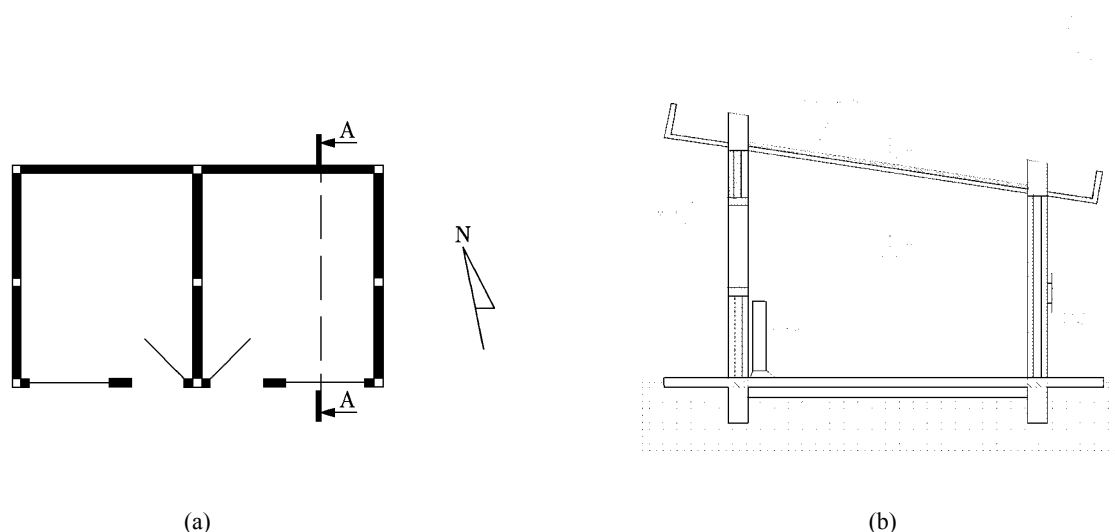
(a) Vista en planta del prototipo y (b) Corte A-A donde se visualiza la cámara de techo del local al este.
